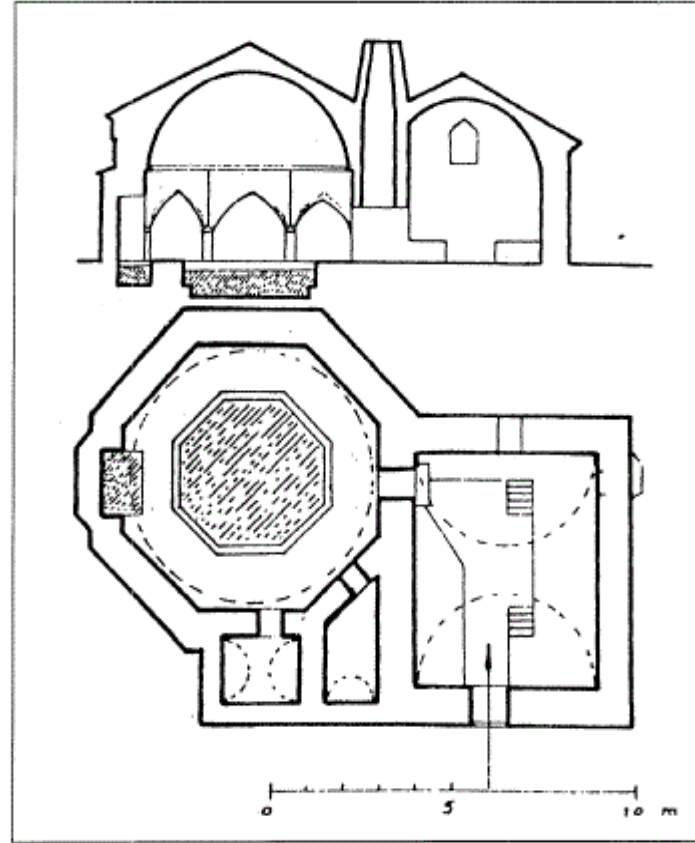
مسقط أفقي لمجمع قلج علي باشا بإستانبول (عن: اصلان ايا).
